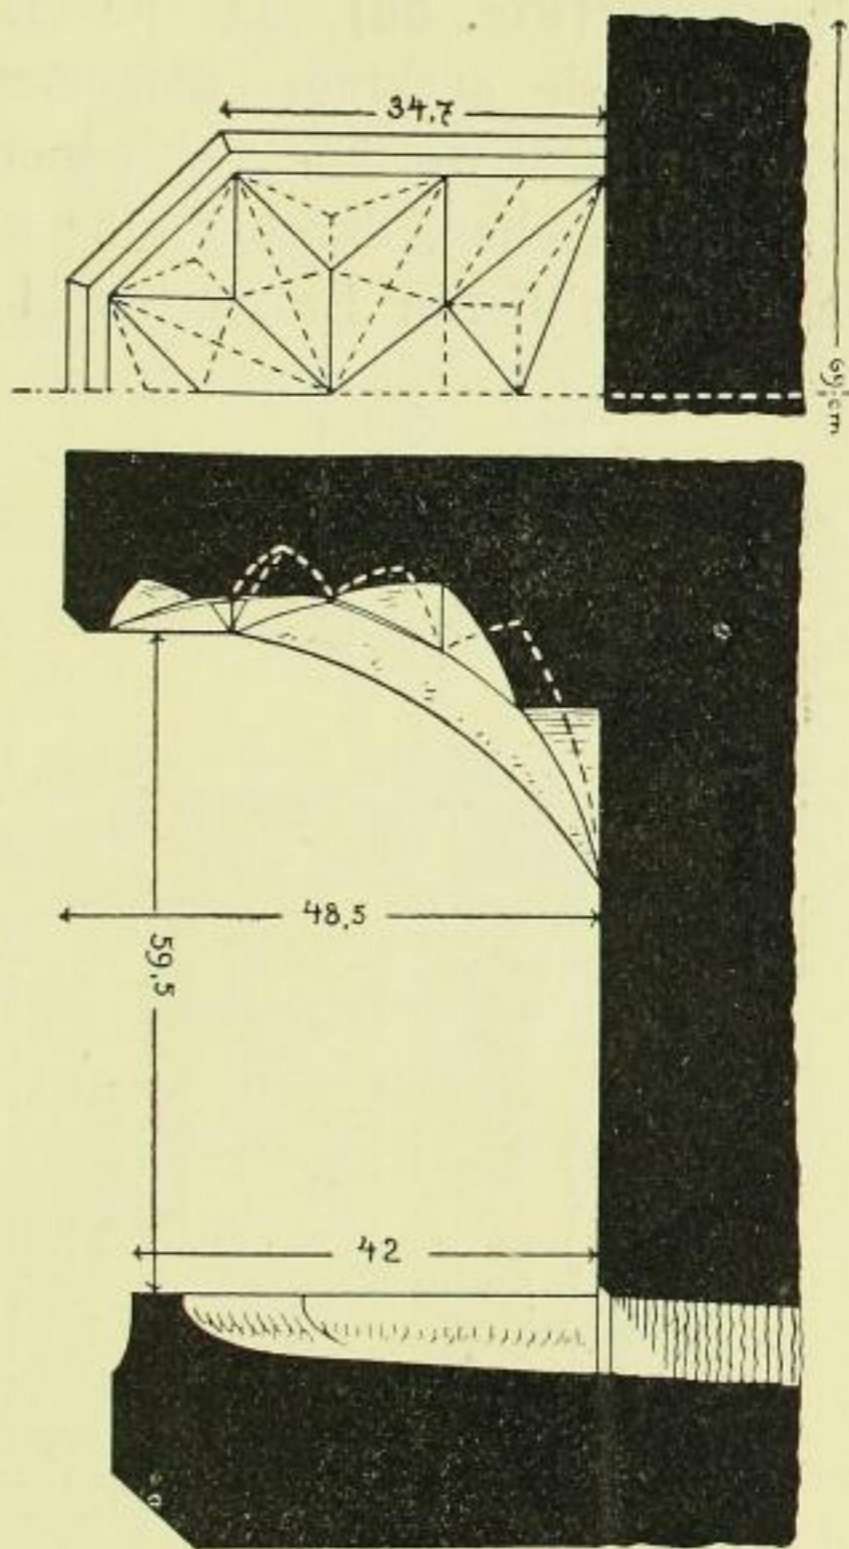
Göda, Kirche, Weihwasserbecken. Schnitt und Grundriß.
